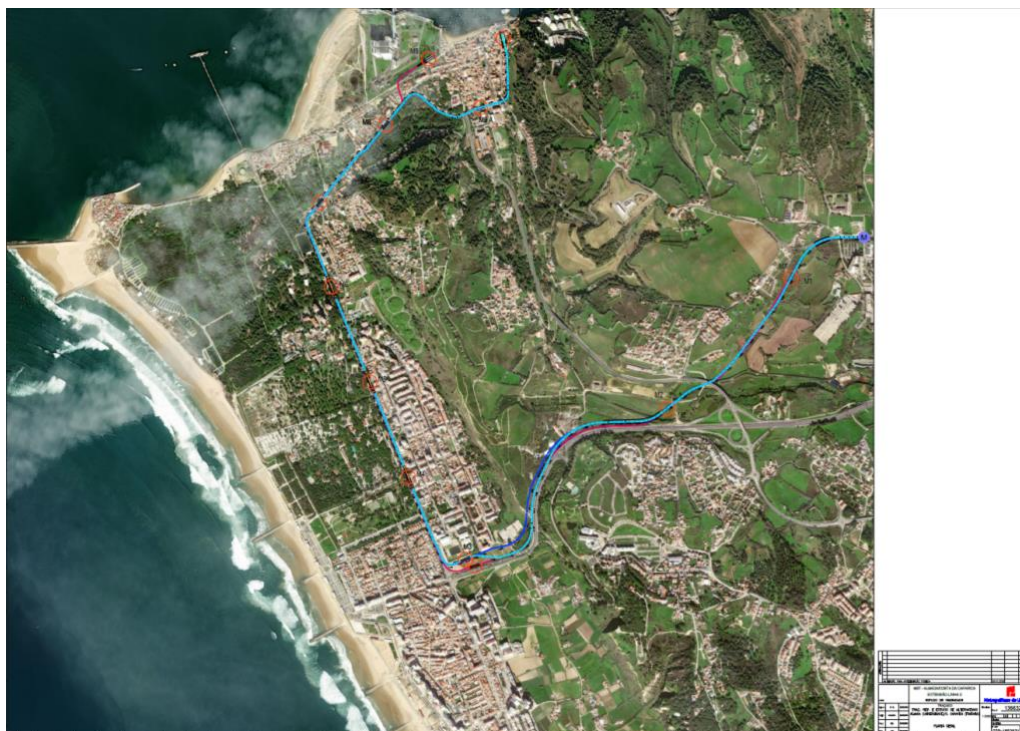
| Traçado Base | Consolidação do Traçado de Referência – planta geral
